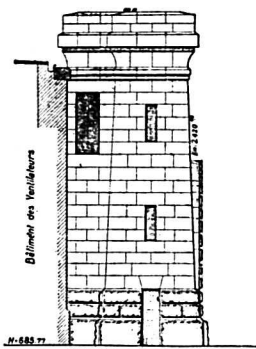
Portail du côté de Brigue. — Vue de côté.
